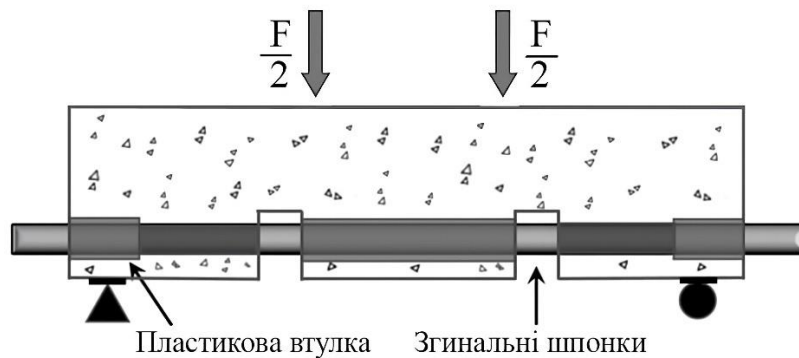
Схема модифікованого випробування кінців балок для дослідження зчеплення арматури з бетоном [59]
